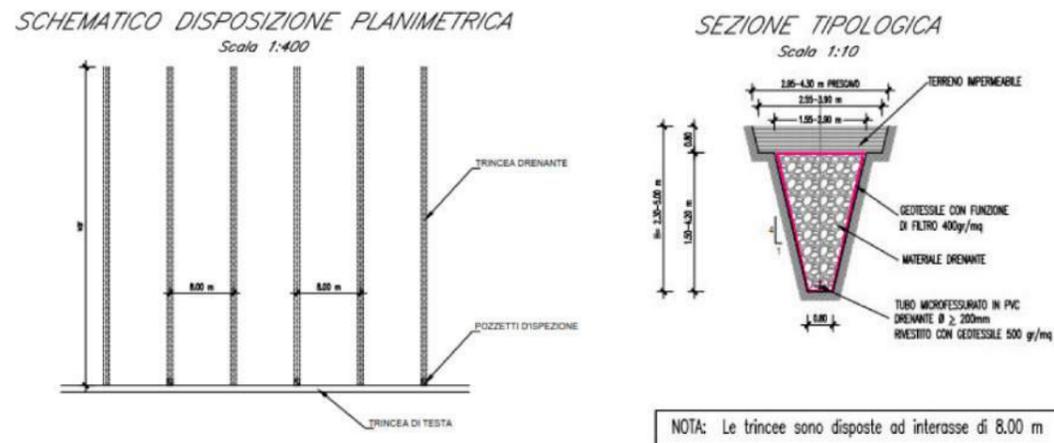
Disposizione planimetria e sezione tipologica delle trincee drenanti
